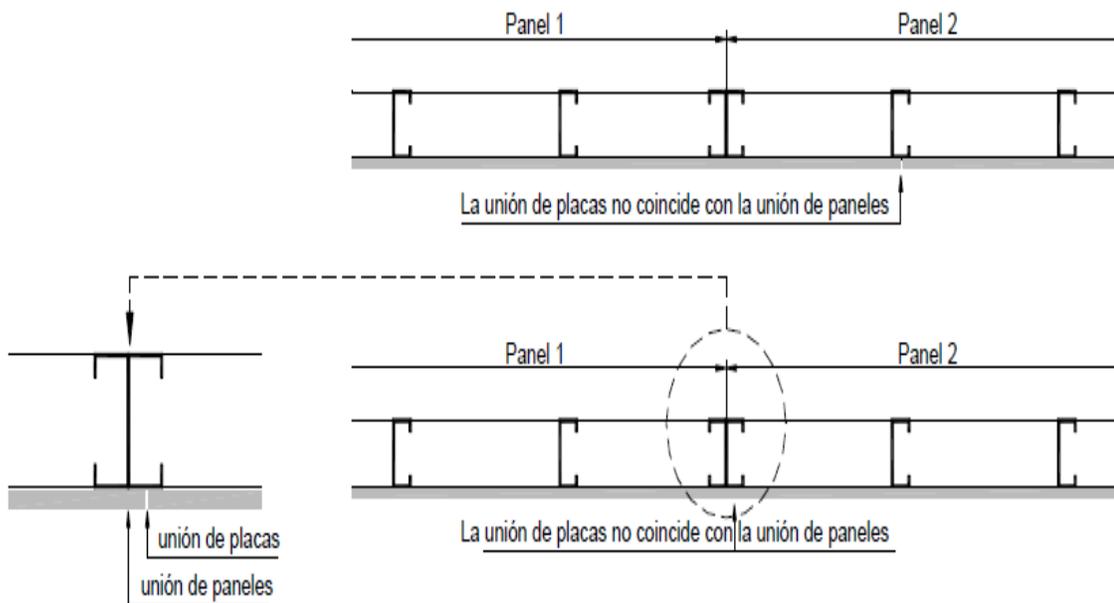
Tipos de solapadas de uniones entre perfiles y placas.
